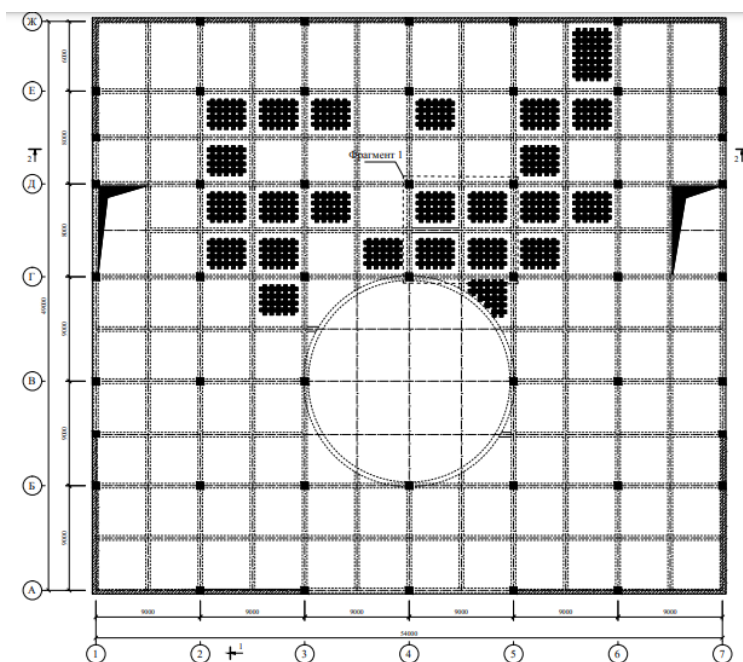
Схема усиления железобетонных плит перекрытия потолка нижнего уровня на отметке 0,000 фиброармированными пластиками (материал авторов).
